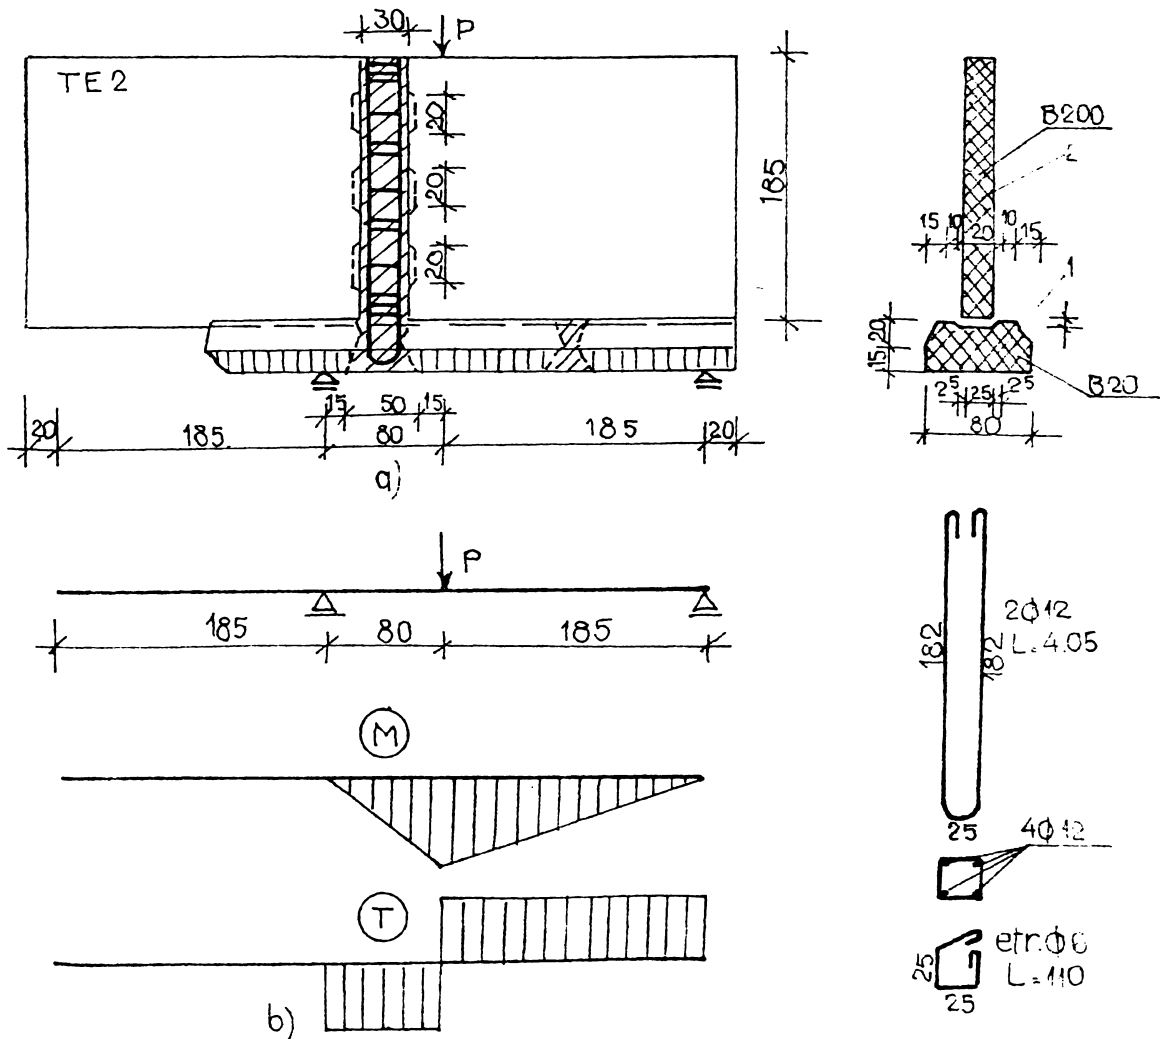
Elementul TE₂. Schema statică: a- alcătuirea elementului ; b -schemă statică; 1- talpa; 2- elevația.
